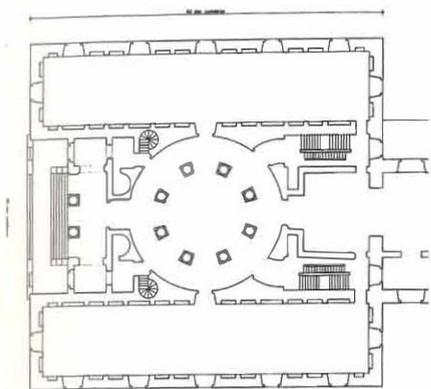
Planta superior del ala norte en el proyecto ejecutado.
